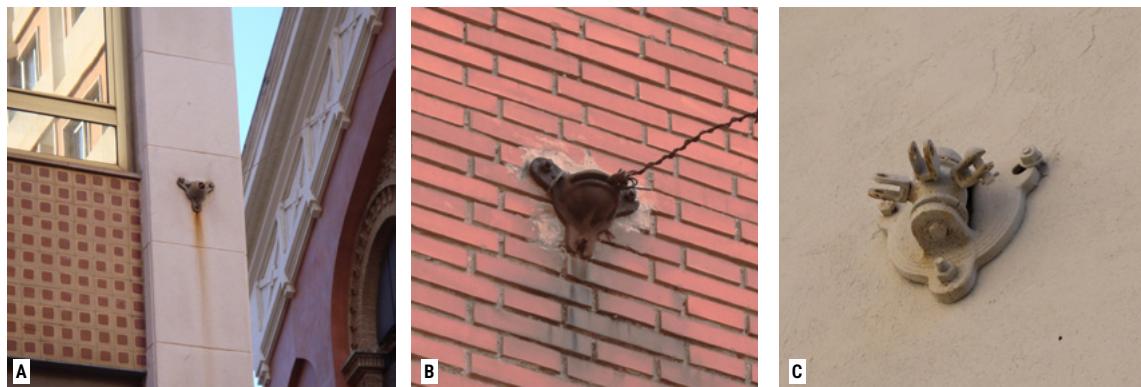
A. Roseta instalada en la fachada del hotel Mindoro de Castelló.
